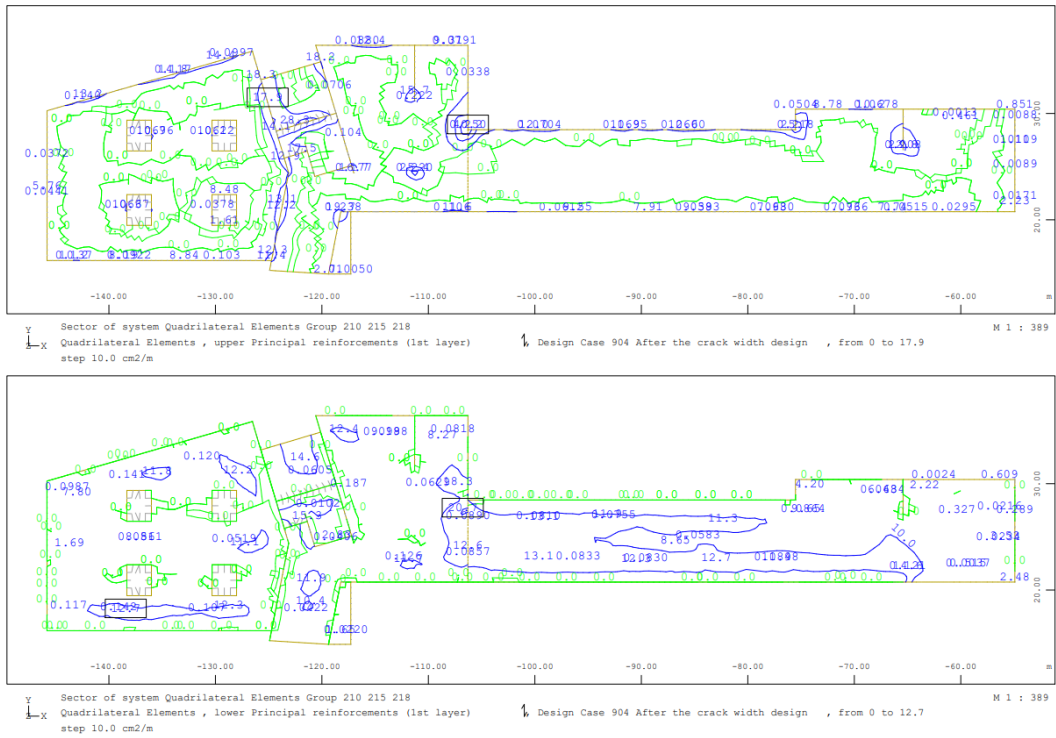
Armadura principal na face inferior (sup.) e superior (inf.) – laje de fundação – acesso Norte - ELS
